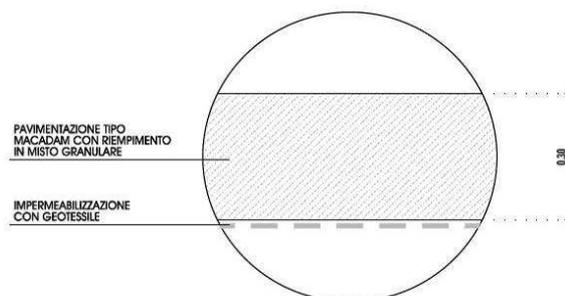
Stratigrafica pacchetto stradale pista di servizio
